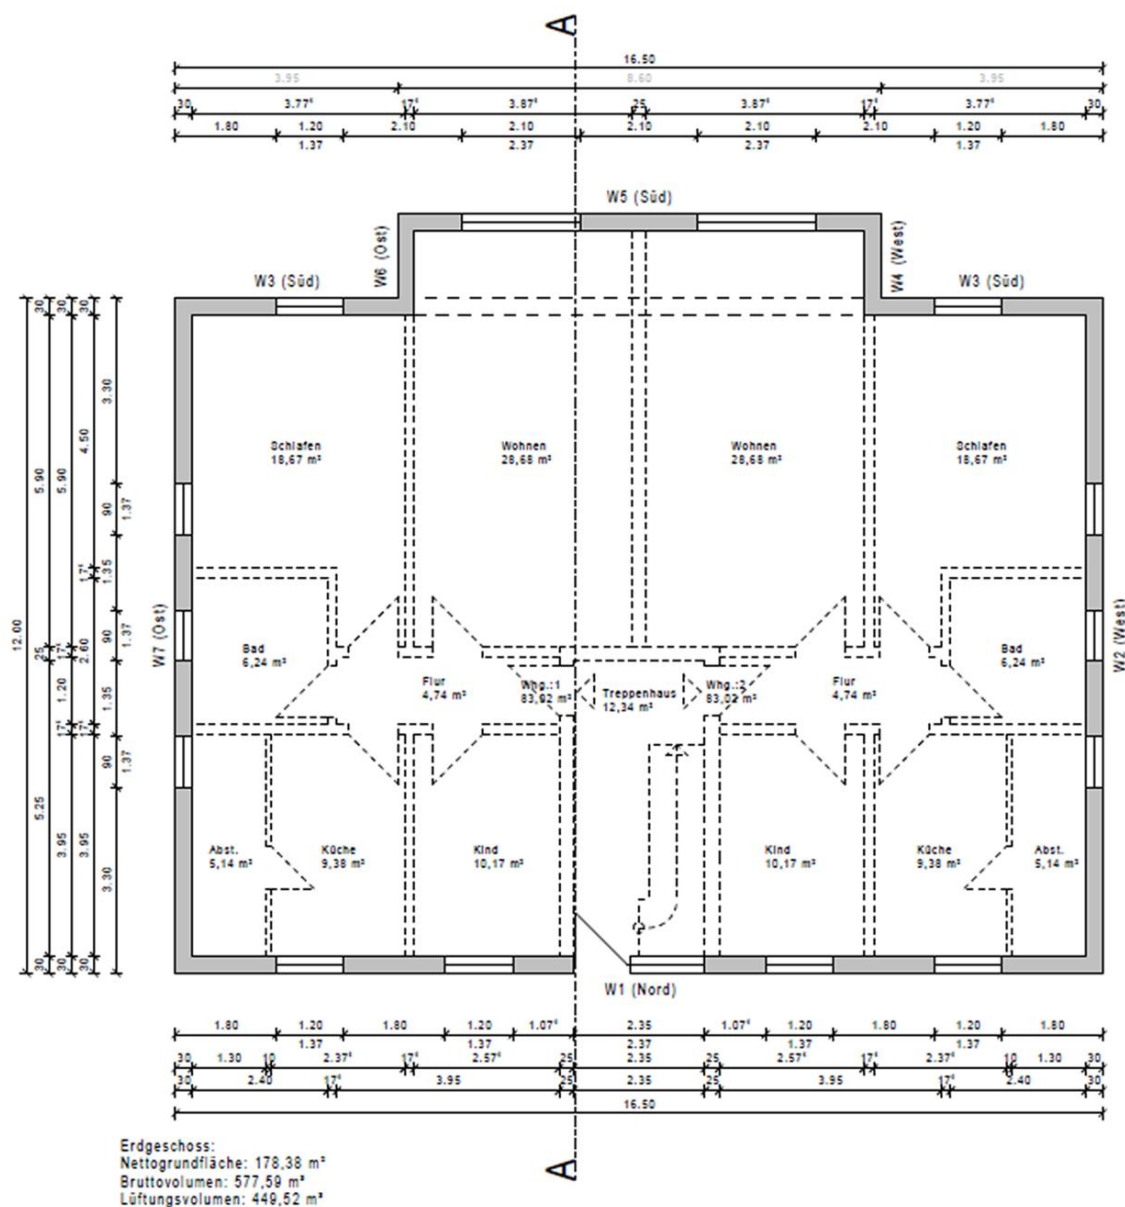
MFH - Grundriss Erdgeschoss
